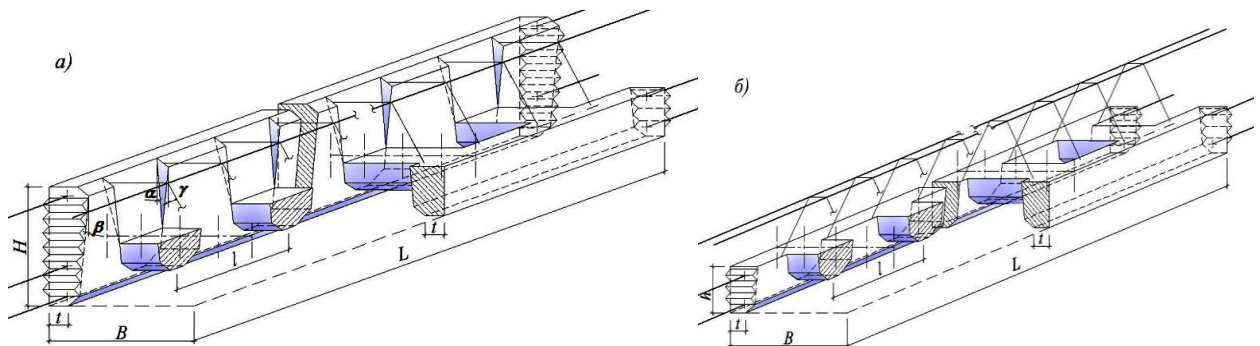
Сборный поясной блок длиной $L \geq 7 \div 8$ м на пролет наружных (а) и внутренних (б) стен здания (в аксонометрии с частичным вырезом), где смежные ветви соединены между собой перемычками и содержат выпуска поперечной и продольной арматуры, и клиновидные шпонки [разработка автора].
